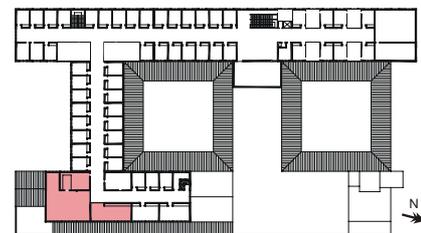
Localização dos Ateliês. Segundo Pavimento. Obra construída. (Desenho da autora).
